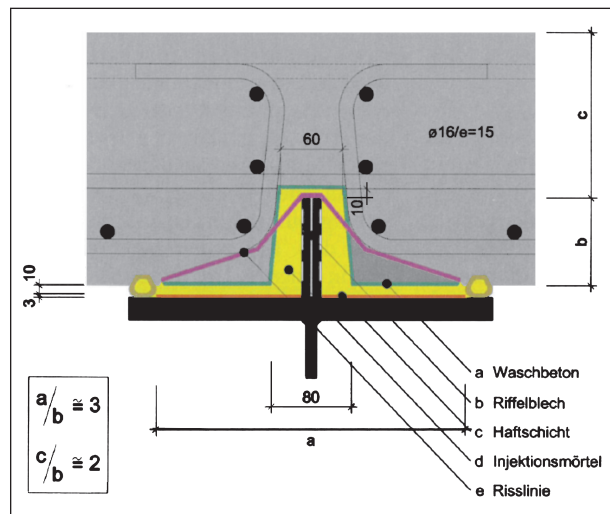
Verbundfuge – Abmessungen, Proportionen, Bewehrung und Risslinie [15]
